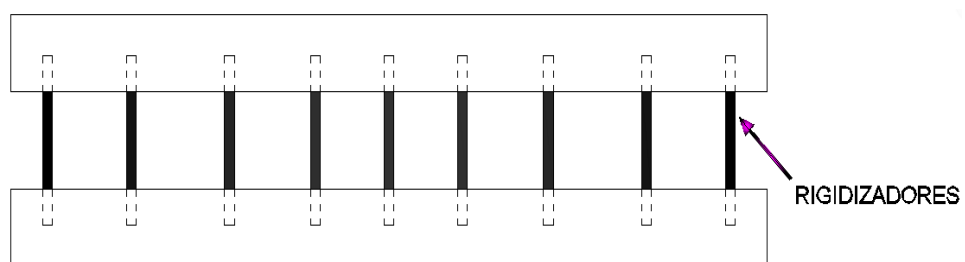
Rigidizadores internos de la viga (vista superior de la viga)
